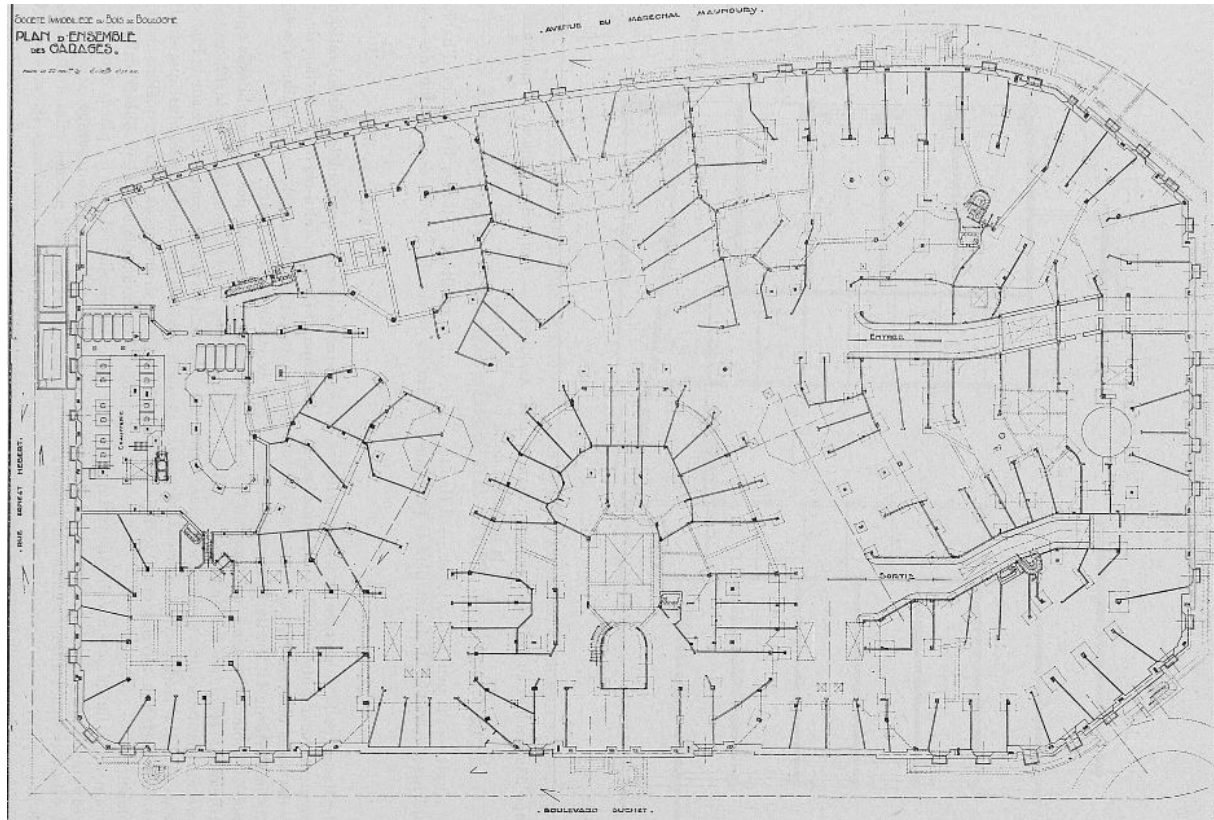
Jean Walter : 2-10 bd Suchet 16<sup>e</sup>, 1931, innovation tempérée, plan des garages, in *La Construction Moderne*, n° 20, 14 février 1932, p. 324.
